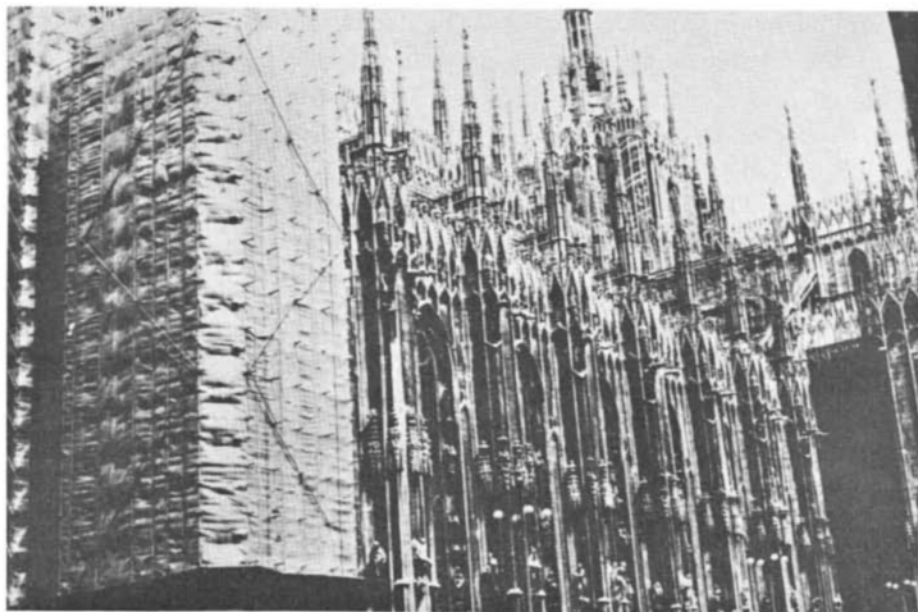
Catedral de Milão. Fachada em obras (1973)
